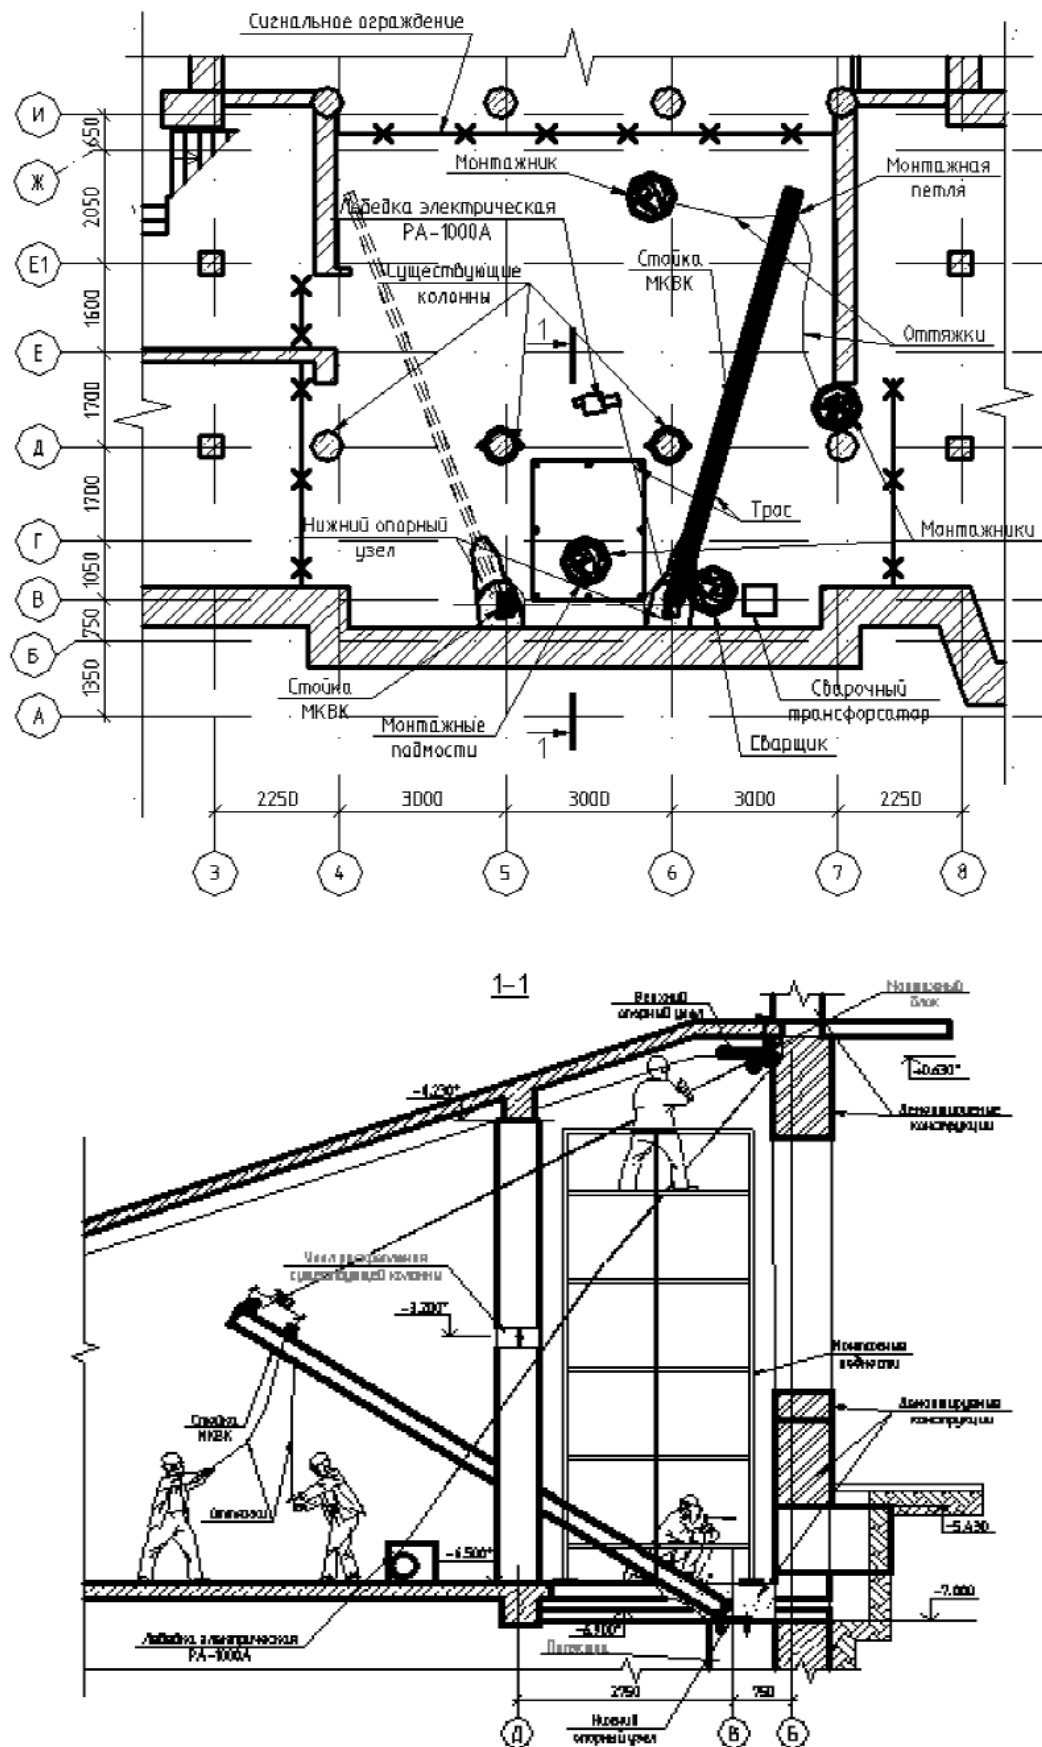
Схема выполнения работ по устройству металлической конструкции временного крепления (МКВК) междуэтажного монолитного перекрытия на период замены участка кирпичной стены
